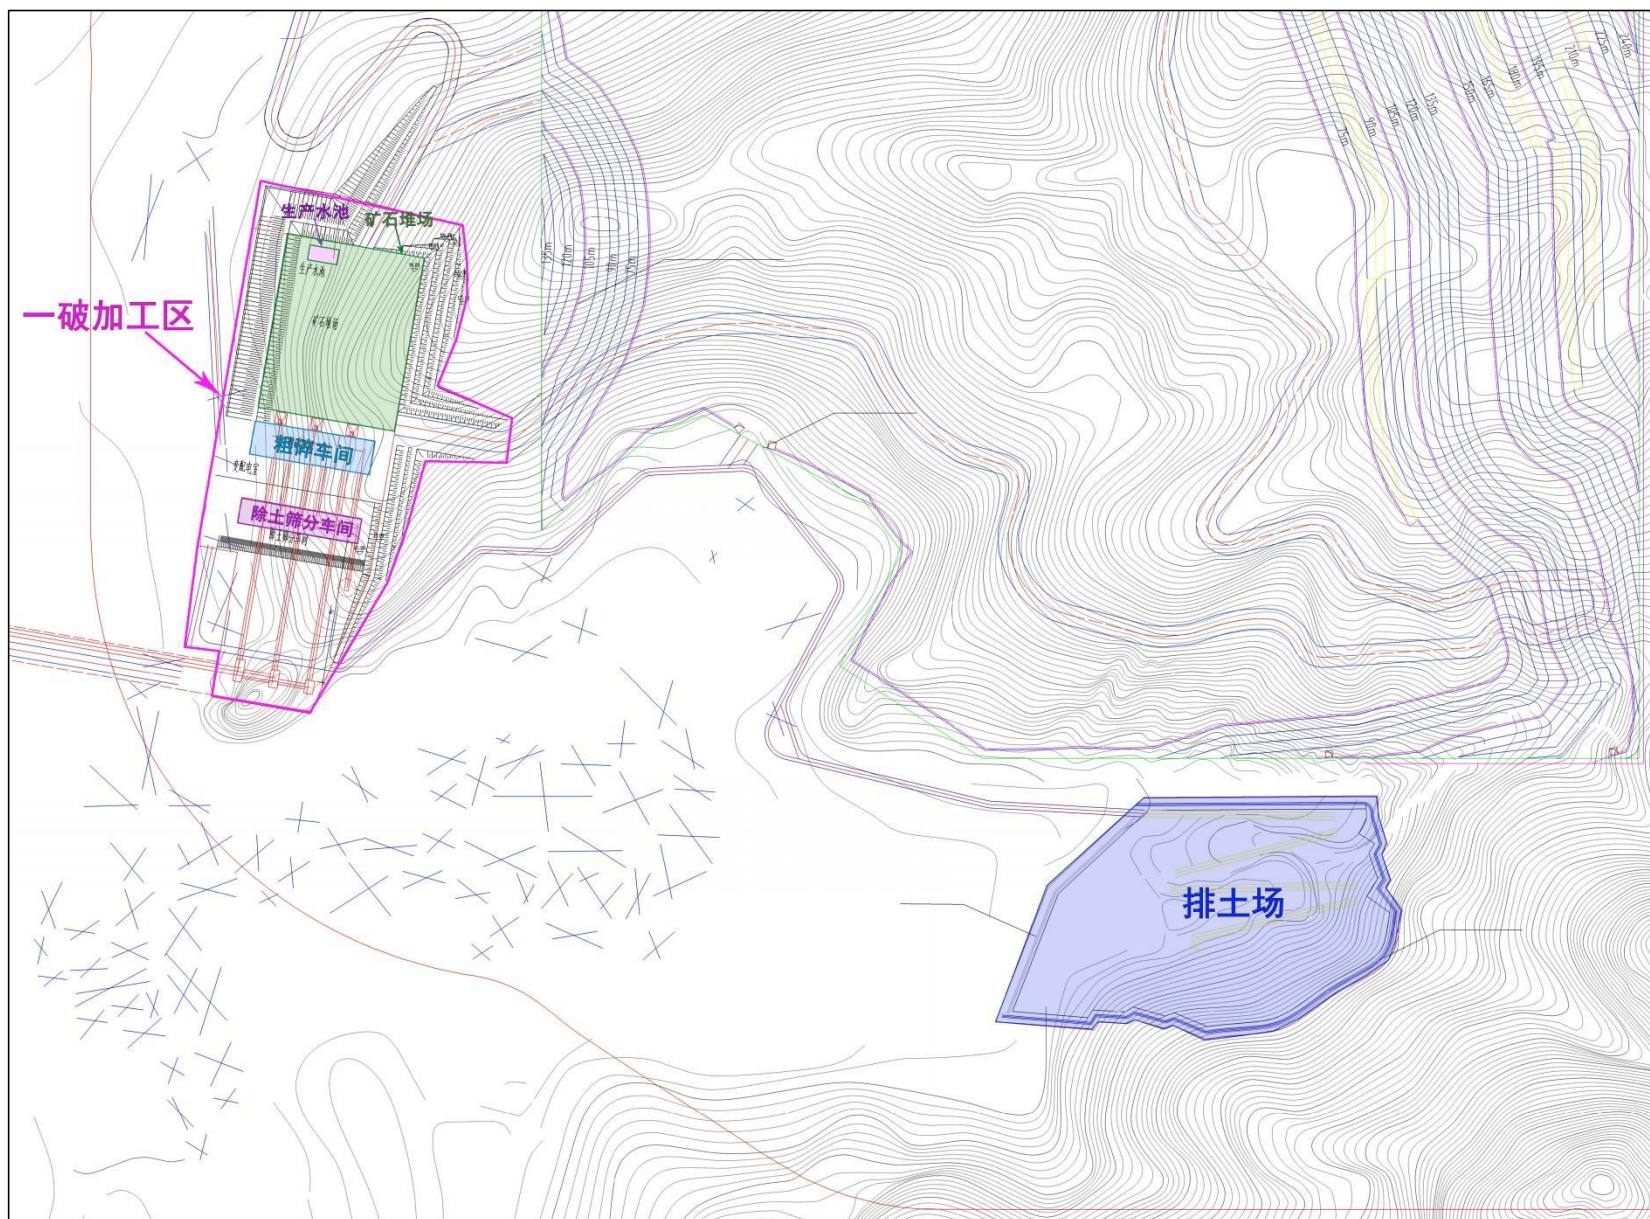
拟建项目一破区及排土场平面布置图
